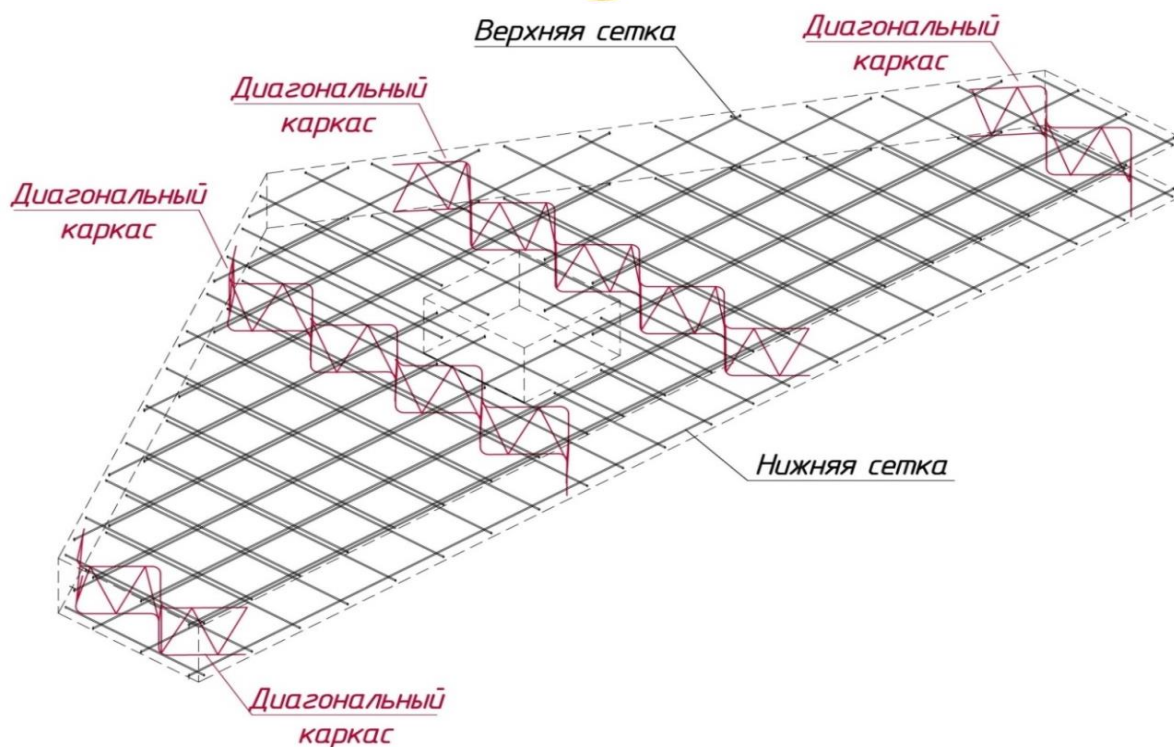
Схема армирования стеновых панелей фронтона диагональными каркасами
